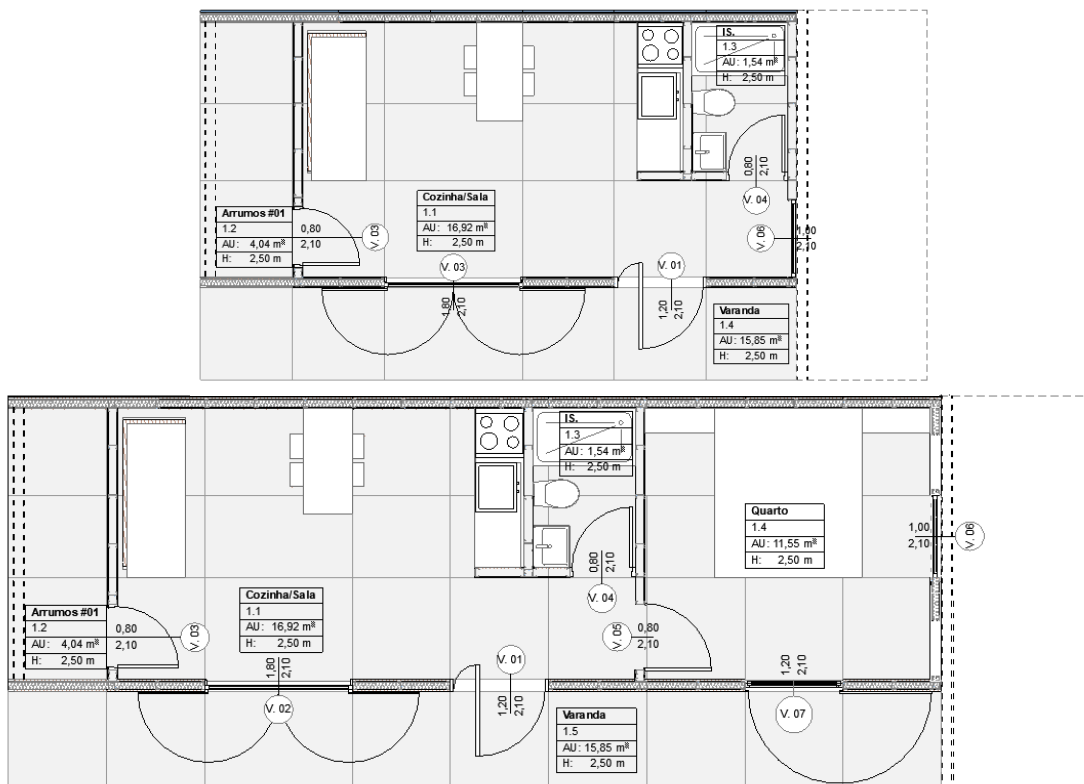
Planta piso 0 do bungalow tipologia T0 e T1 respetivamente (sem escala).
